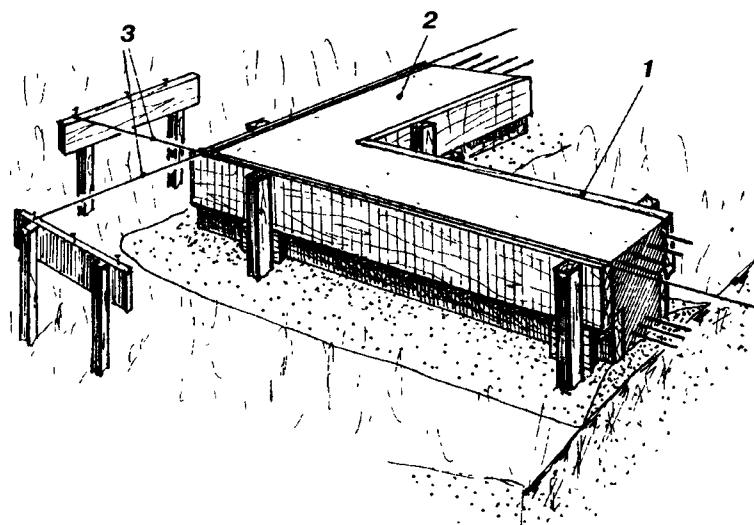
Фрагмент ростверка перед началом возведения стен:
